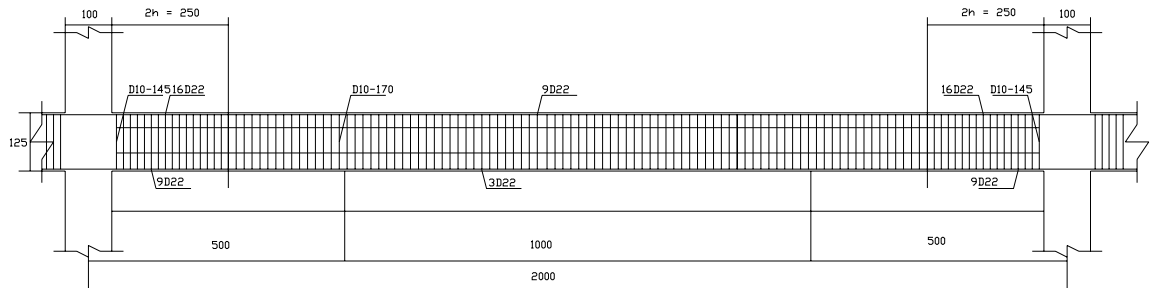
Detail penulangan balok induk 80/125 (cm) lantai 1 model 1
